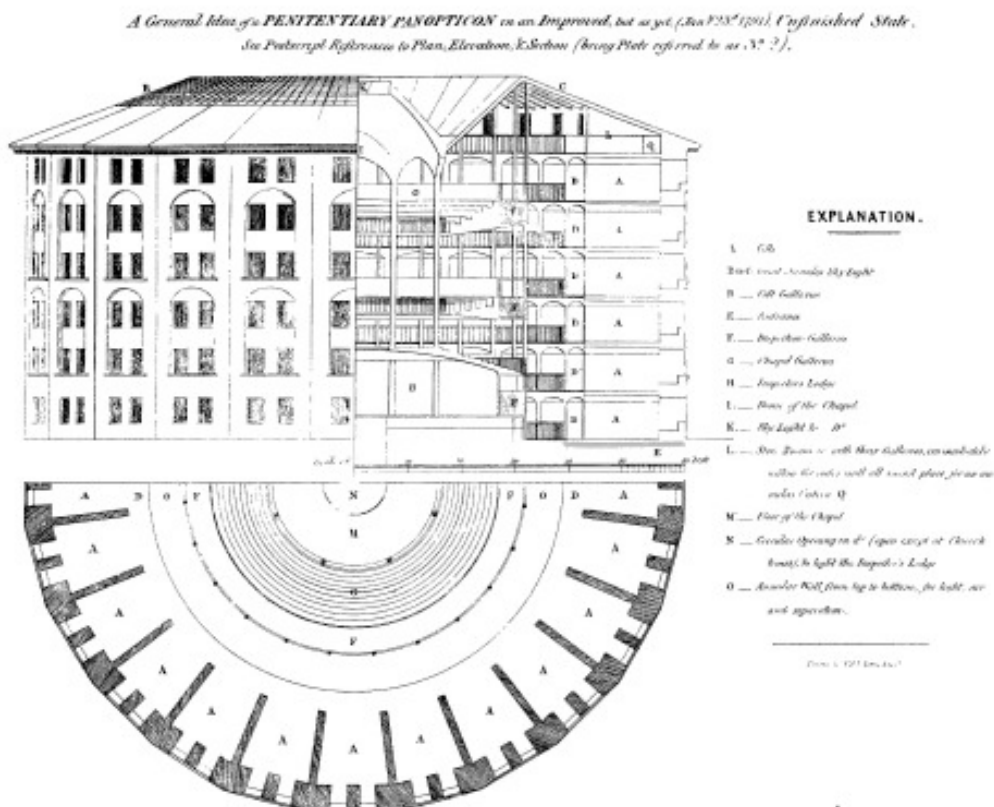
Corte, alzado y planta del modelo de prisión panóptica de Jeremy Bentham, dibujado por Willey Reveley en 1791.
